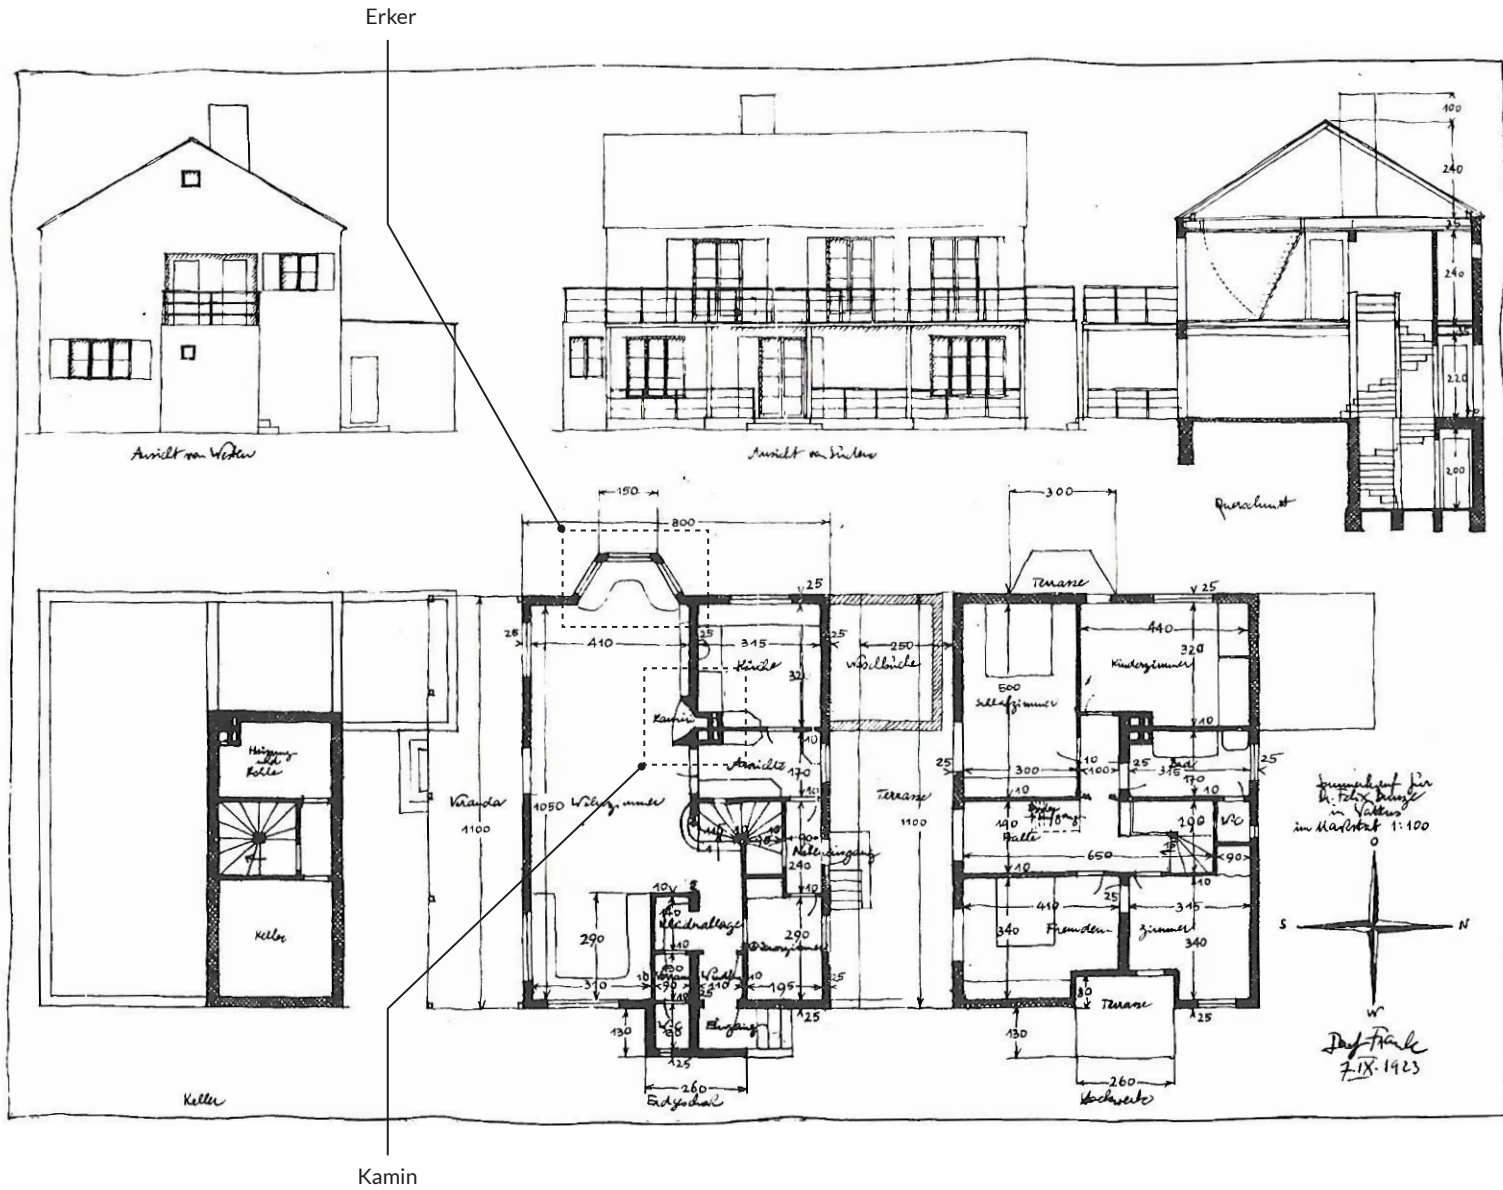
Grundriss Haus Dr. Felix Bunzl
